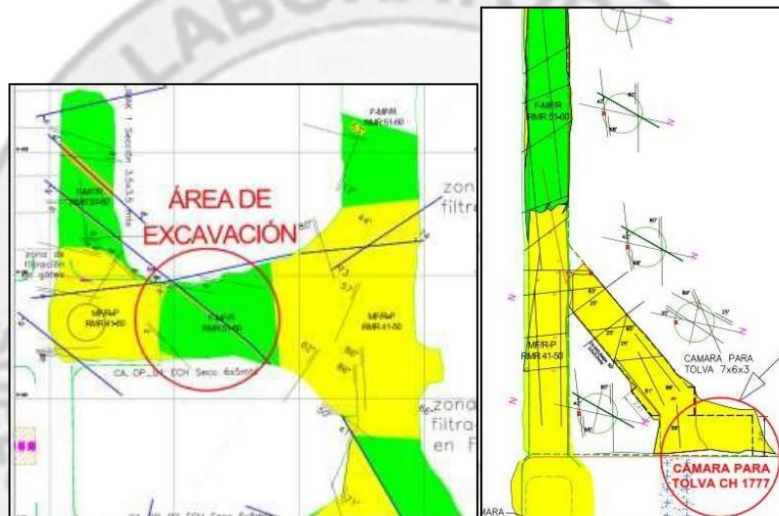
Vista en planta y sección de la cámara para tolva de la Ch 1777.
